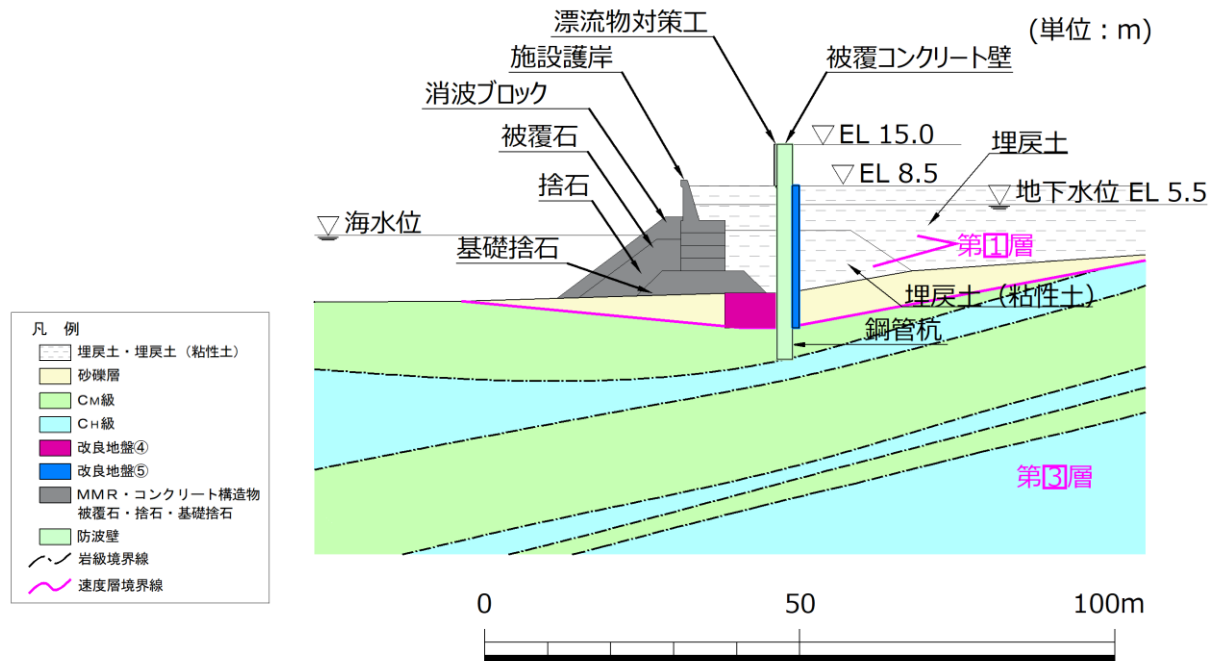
防波壁（多重鋼管杭式擁壁）の横断面図（②-②断面）
